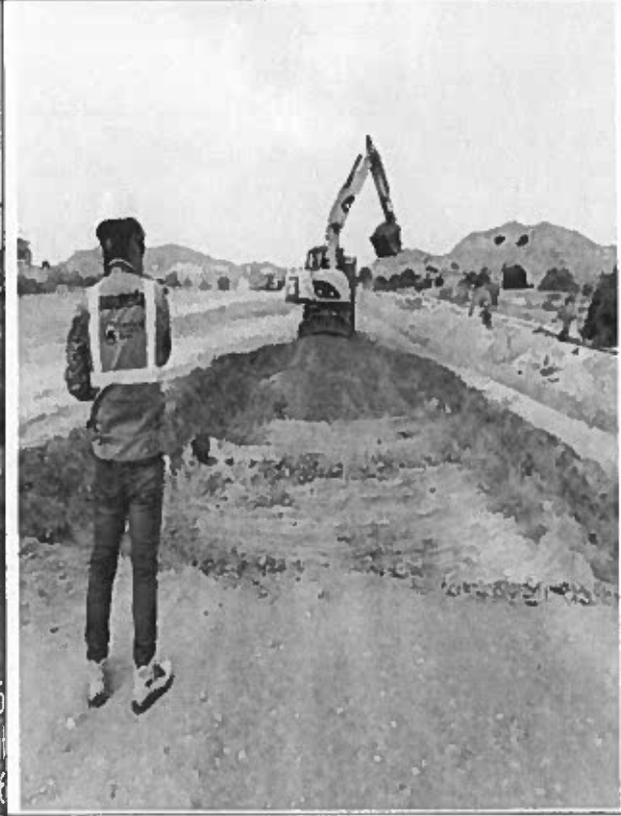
Excavación de terreno para alcantarilla de protección n.º 89 progresivo km 6+670 aproximadamente del PI - 115.
